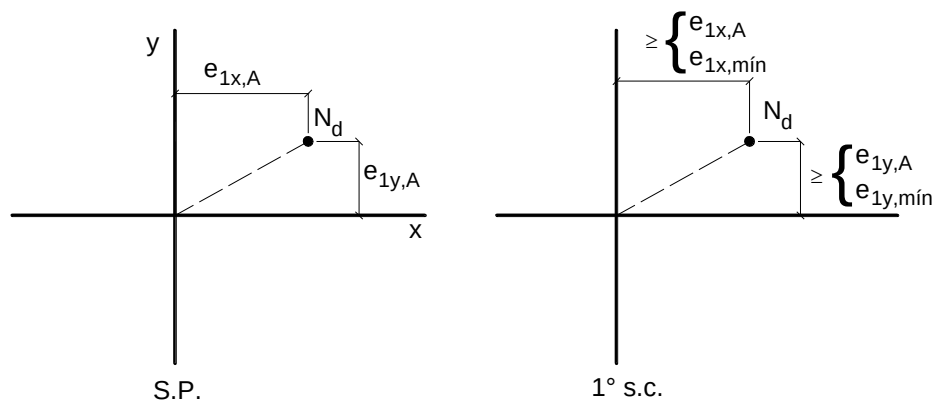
Situação de projeto e de cálculo para as seções de extremidade dos pilares de canto.
